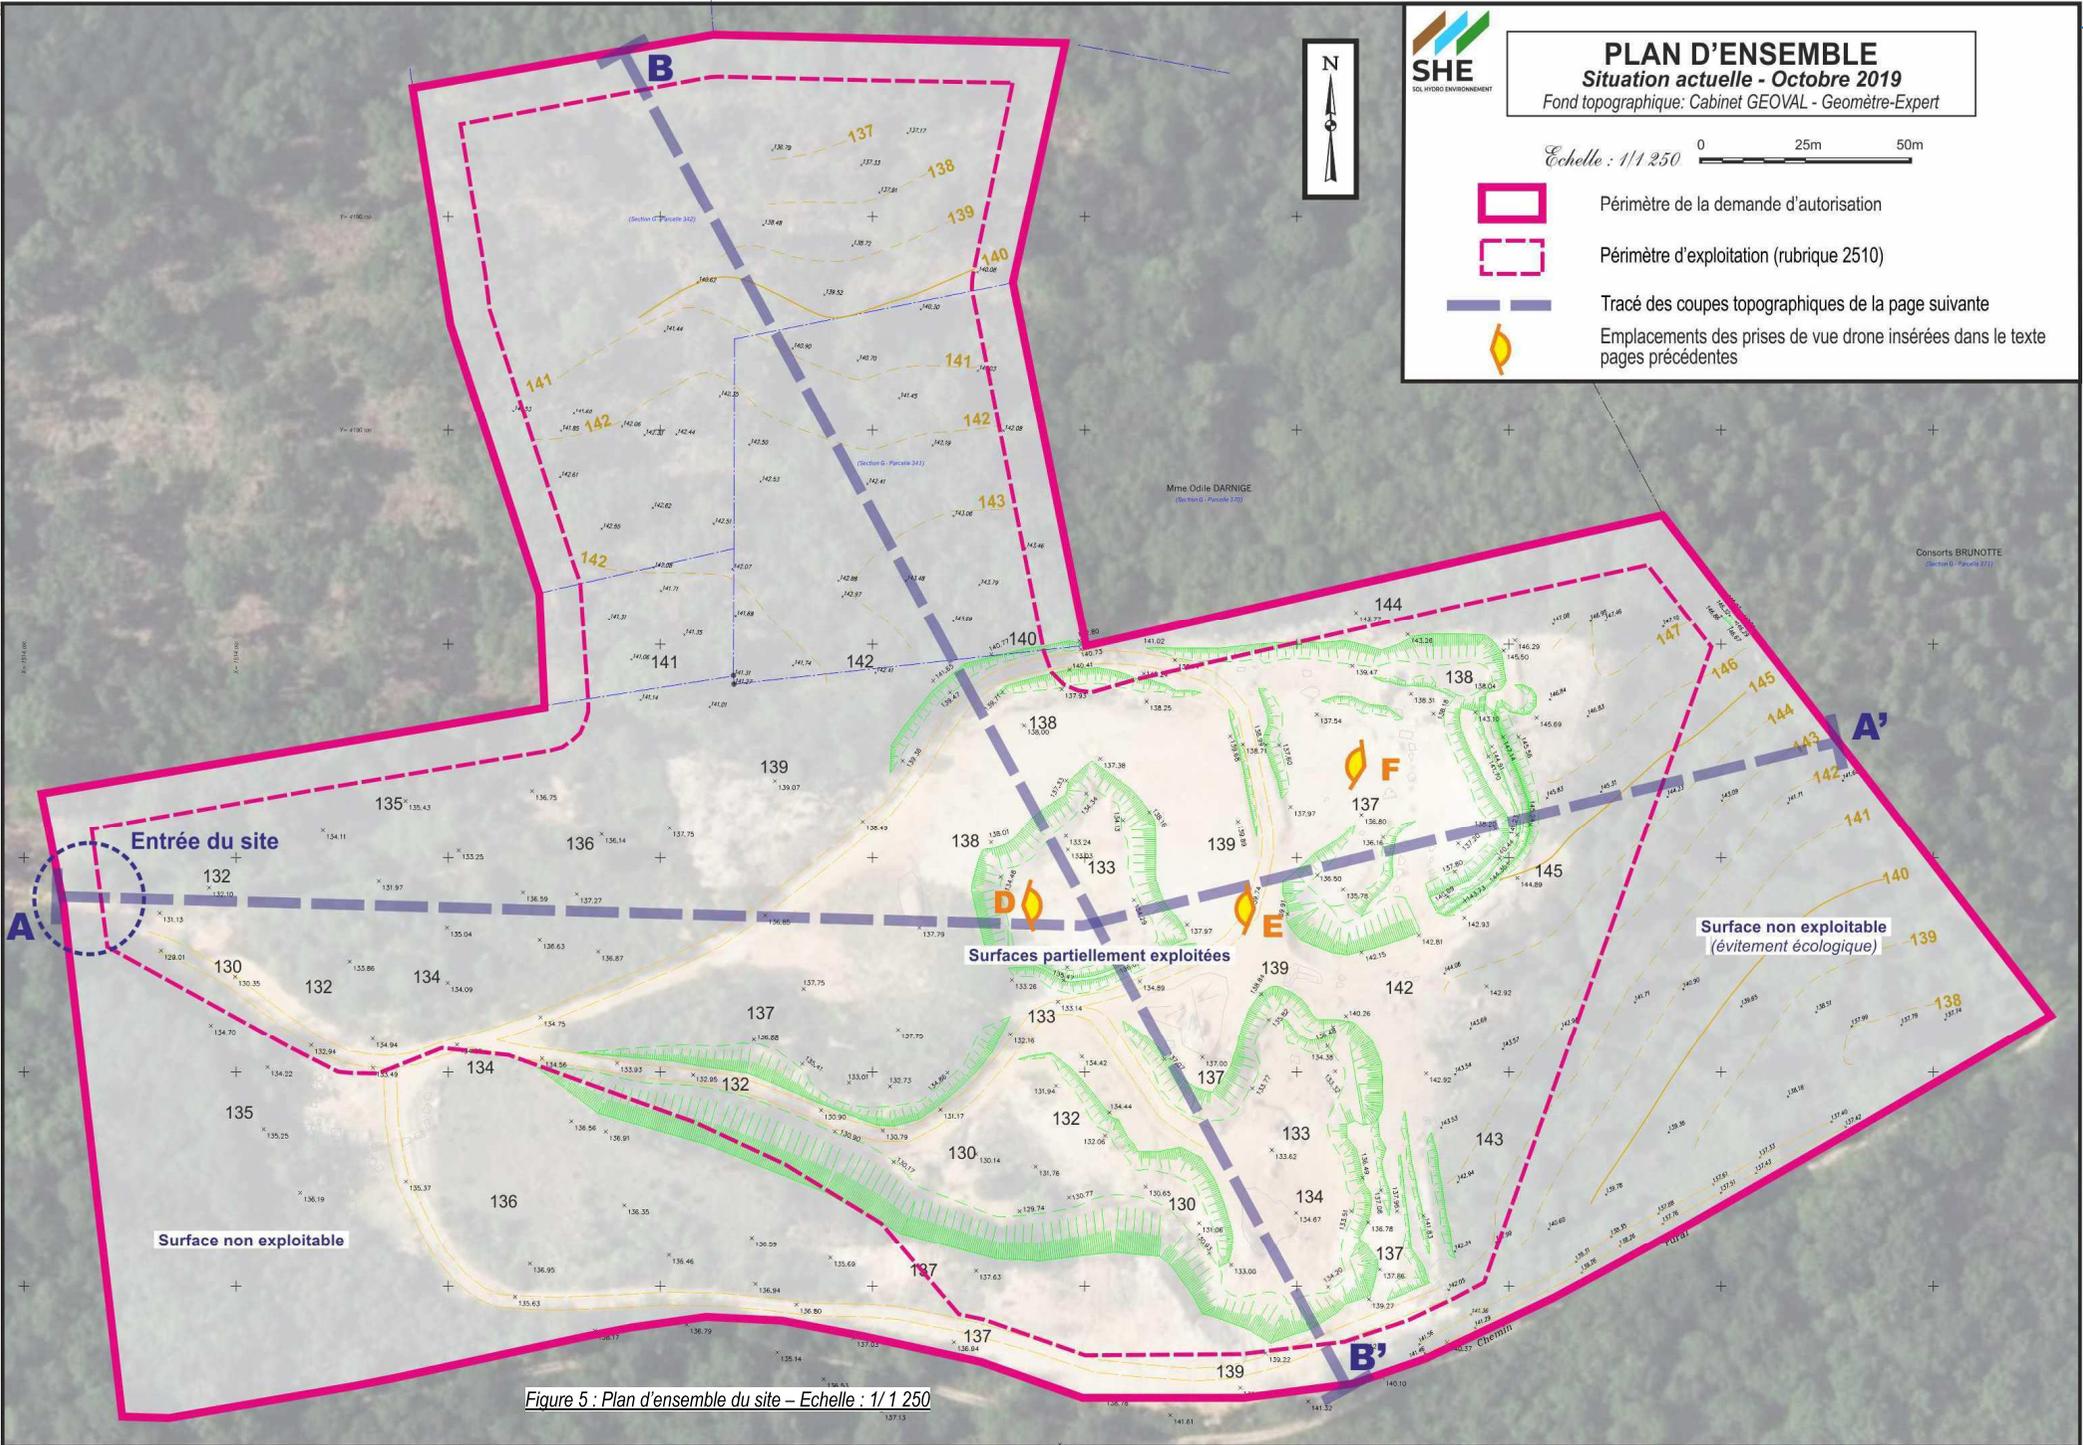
Plan d'ensemble du site – Echelle : 1/1 250
